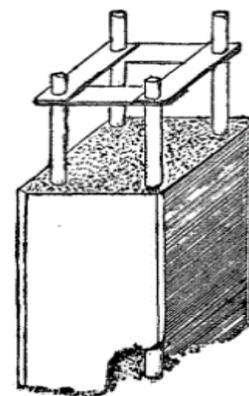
Pilares de hormigón armado (Gallego, 1912)
